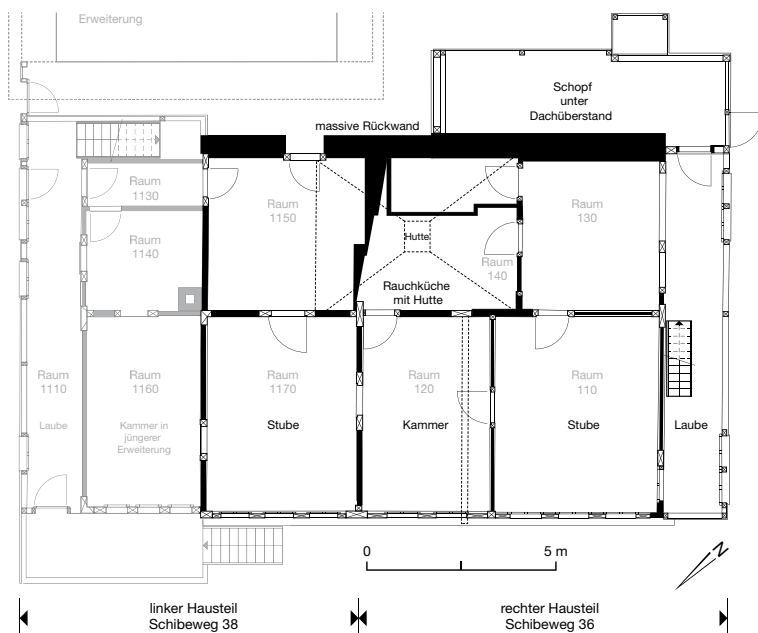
Saanen-Gstaad, Schibeweg 36/38. Grundrissplan zum Erdgeschoss. M. 1:200.
